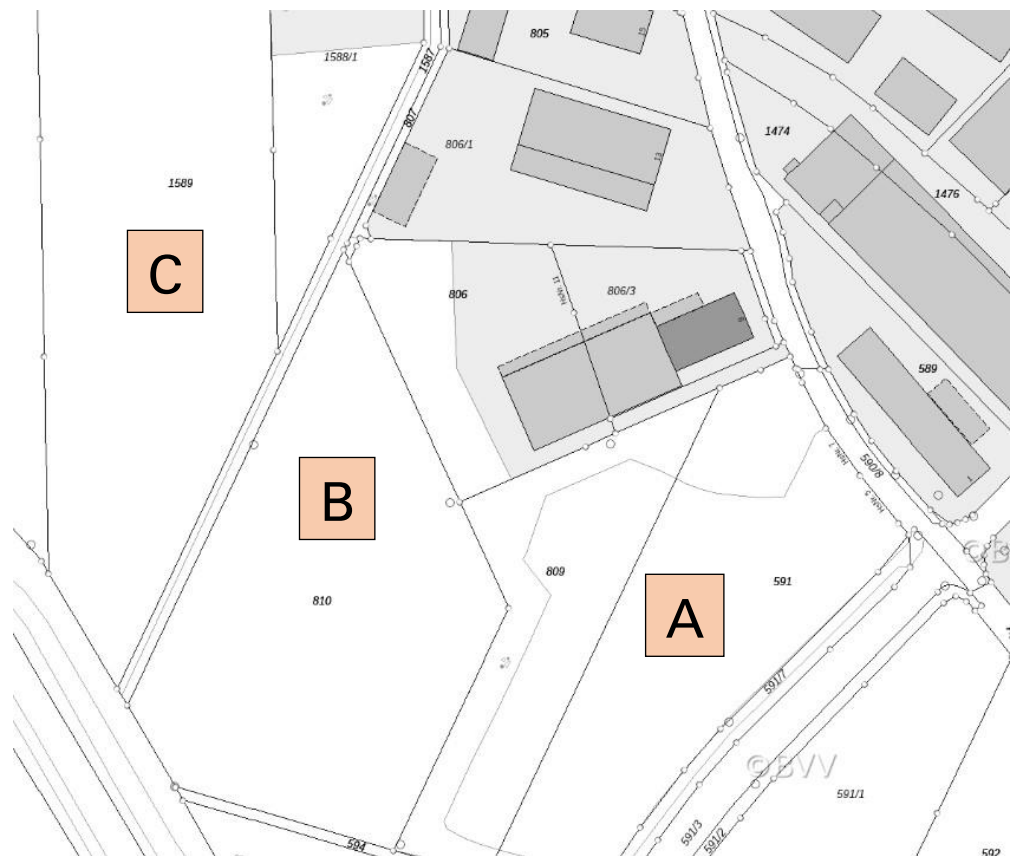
Lageplan (ohne Maßstab) des Betrachtungsgebietes
